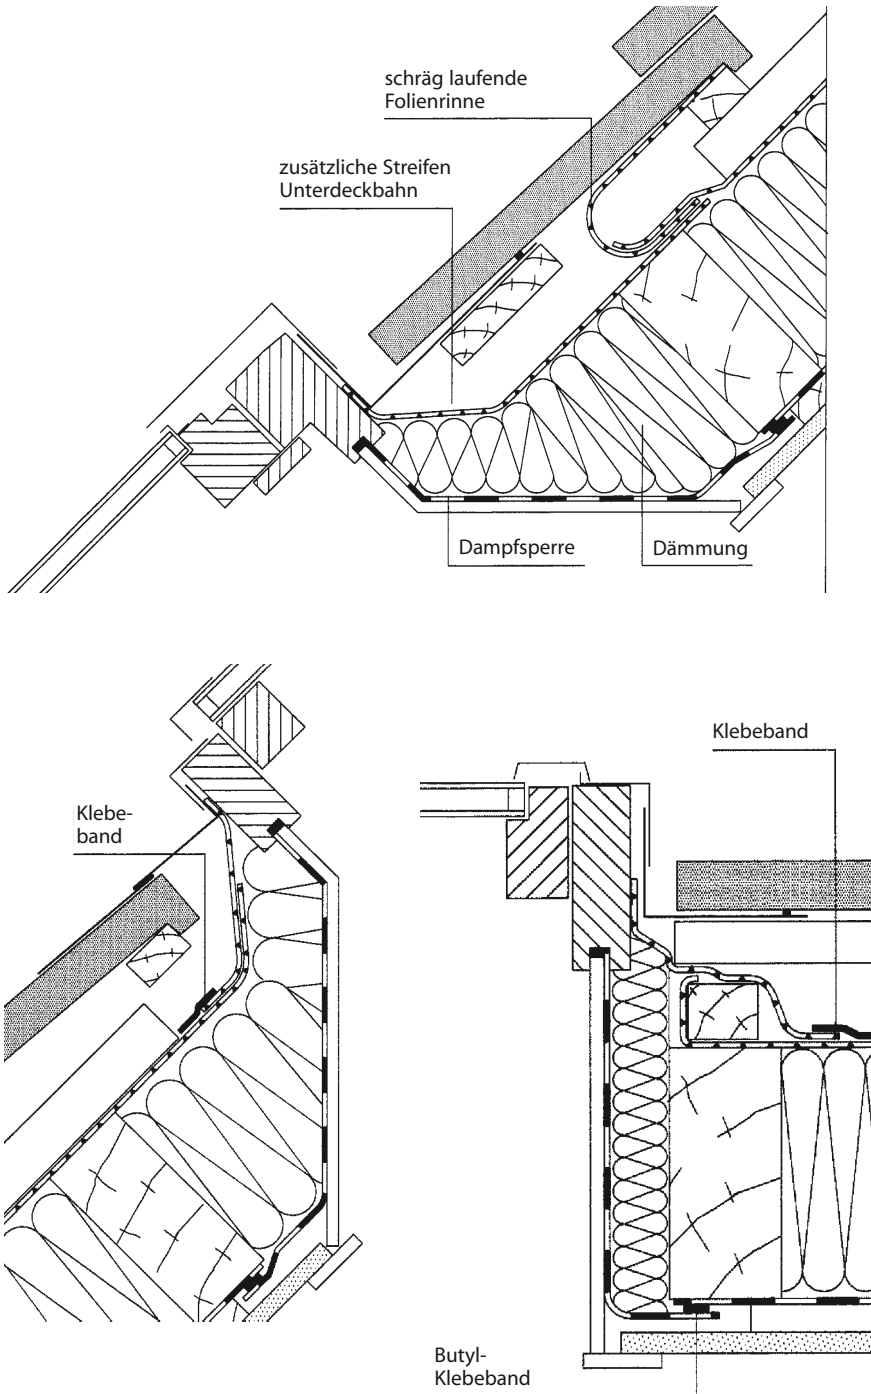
Anschluss von Dachflächenfenstern mit separatem Eindeckrahmen an eine Unterdeckbahn in einem Dach mit Zwischensparrendämmung mit Führung der Bahnen unter die Dachlatten (Quelle: ZVDH, 2003)
